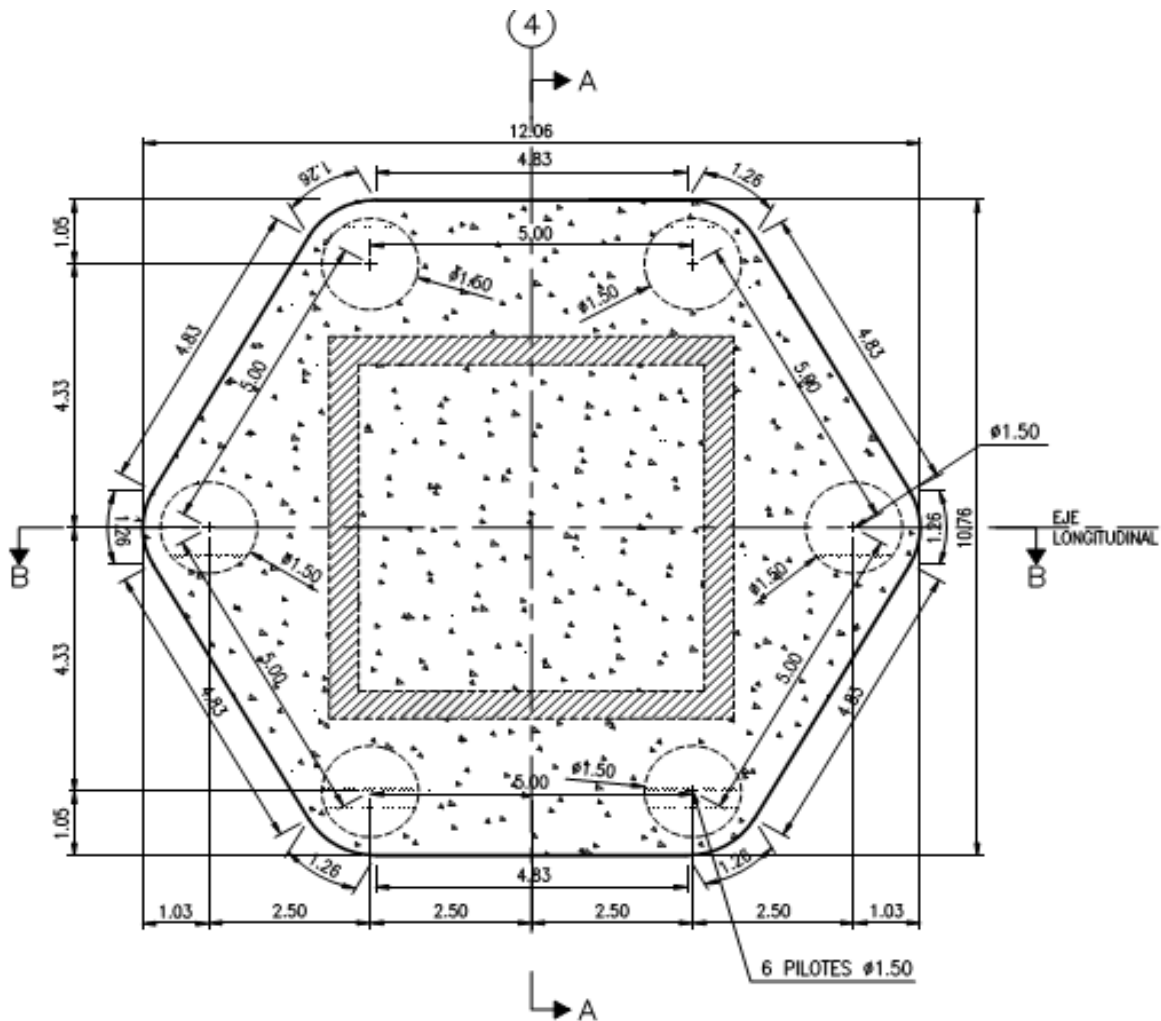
Replanteo para solado de limpieza y ubicación de pila. Fuente: Constructora Colpatria
